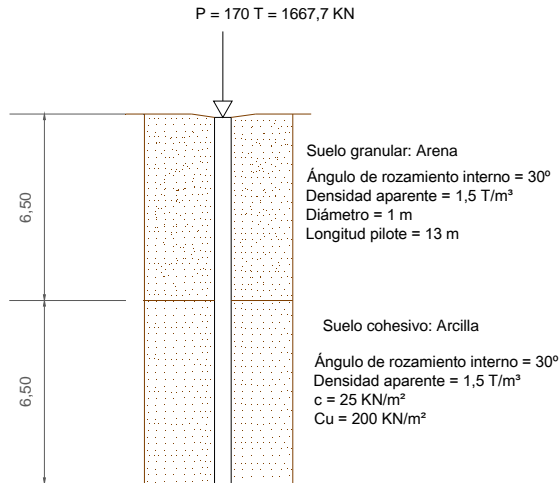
Croquis de pilote en suelo heterogéneo con diámetro 1 m y longitud pilote 13 m
